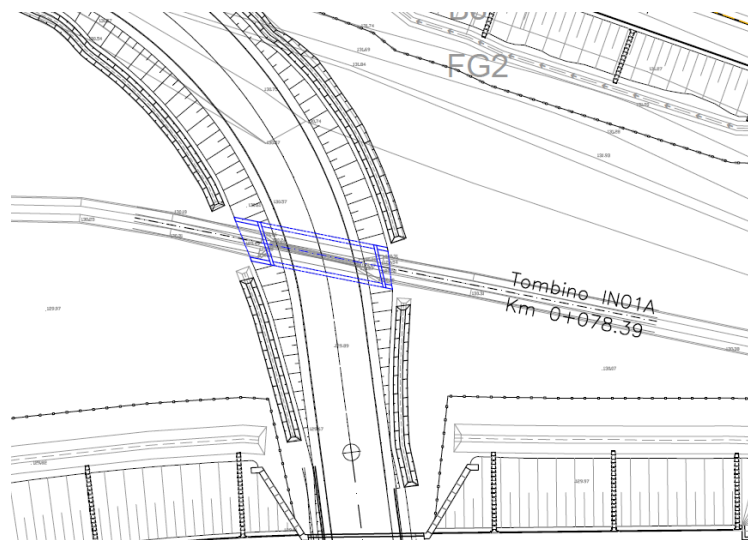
Stralcio planimetrico IN01a – Opere di progetto in blu
